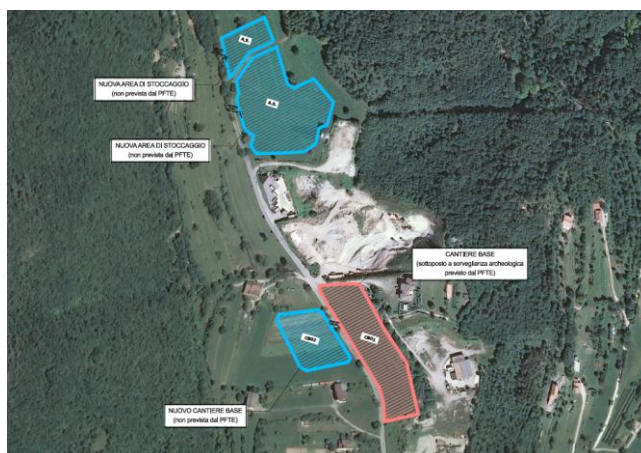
Planimetria di confronto aree di cantiere già previste dal PFTE (rosa) ed introdotto nel PD (azzurro)
